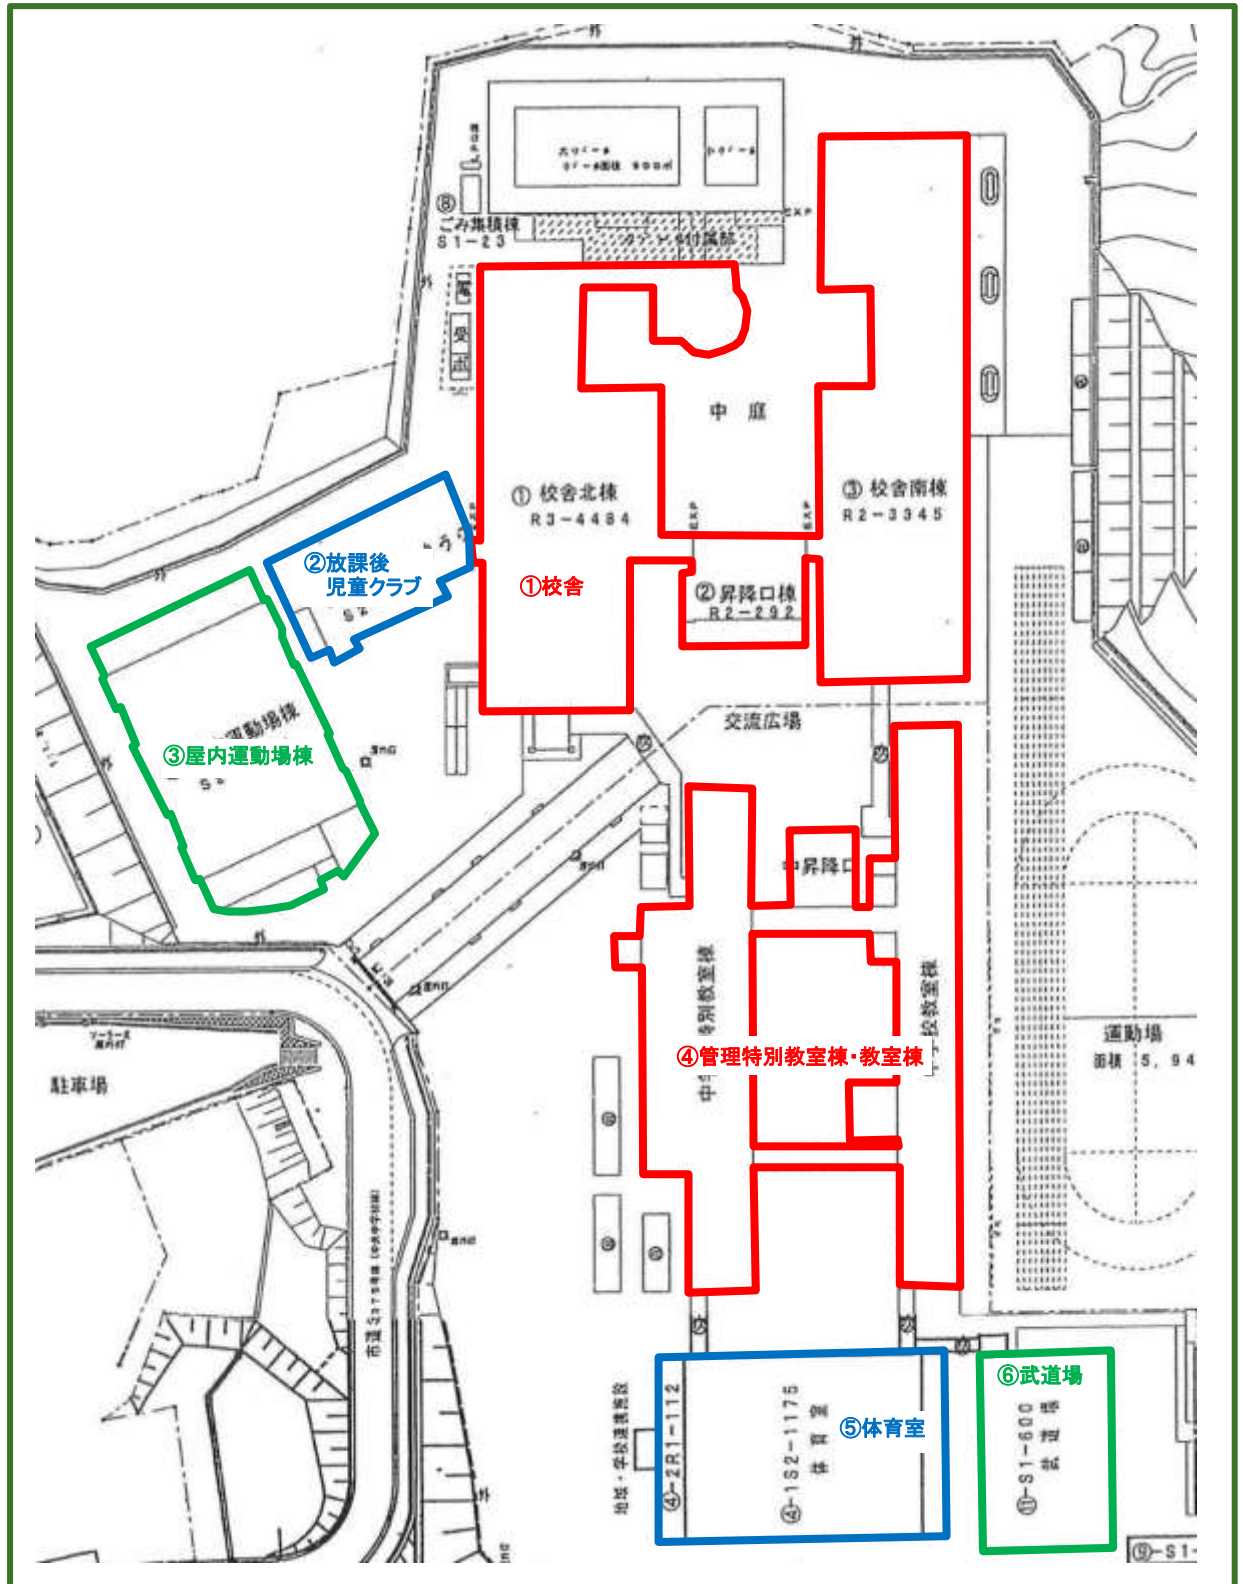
学校教育系施設(東原庁舎中央校)の配置図
